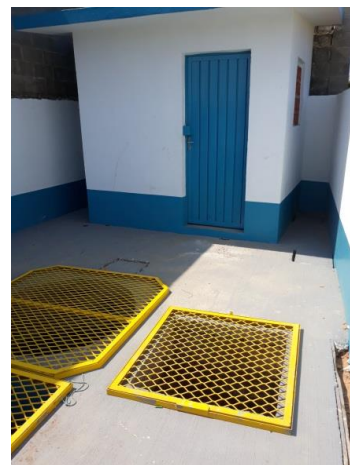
Estação Elevatória de Esgoto – Bandeirantes- Vista 2.
